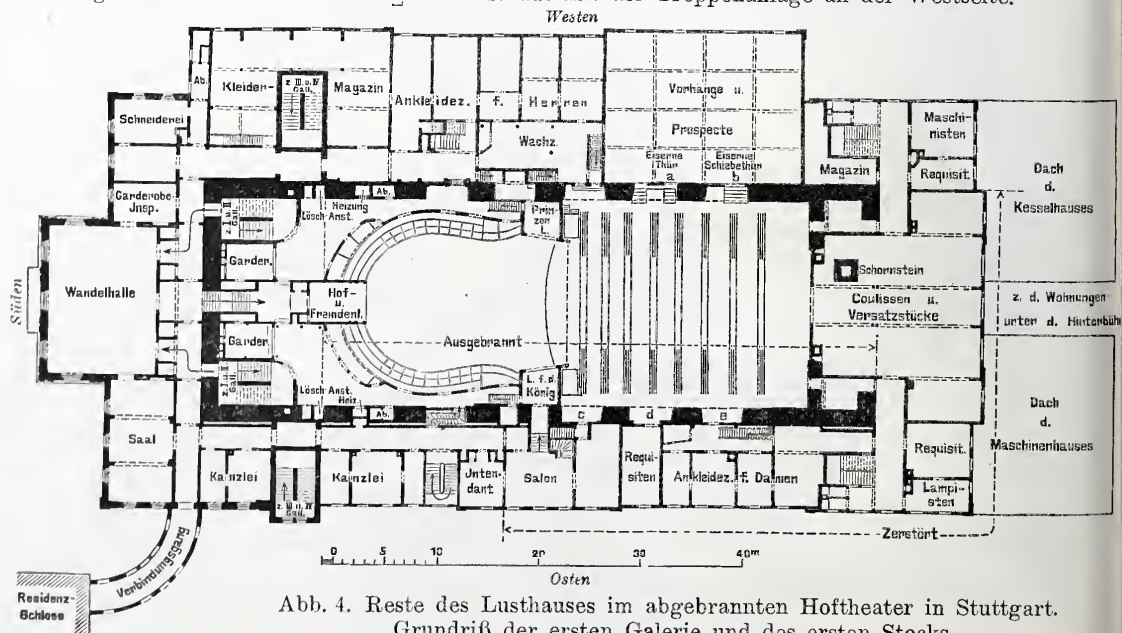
Reste des Lusthauses im abgebrannten Hoftheater in Stuttgart. Grundriß der ersten Galerie und des ersten Stocks.
